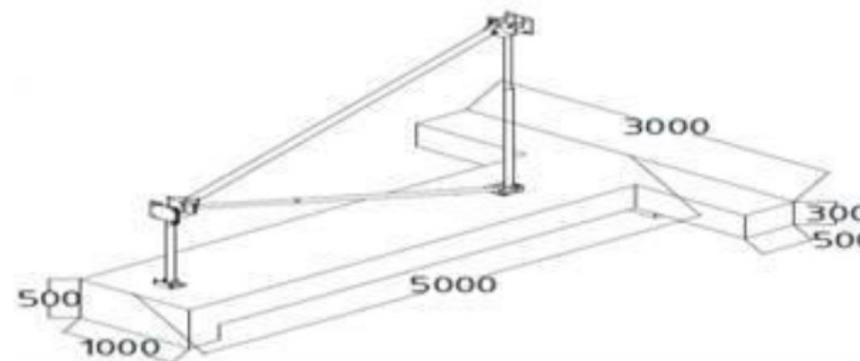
schéma de principe de fondations de type longrine (source EDF EN)
